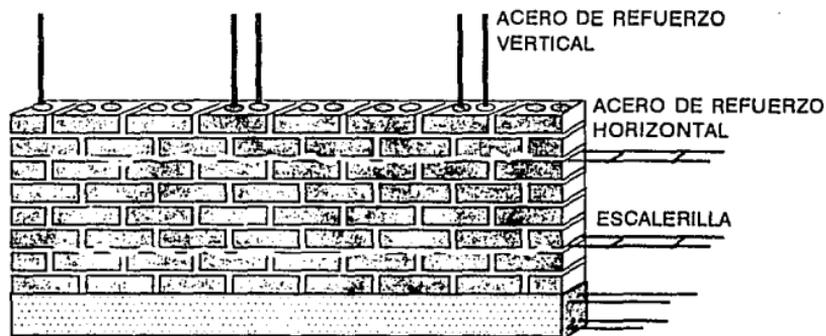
GRIETAS HORIZONTALES POR OXIDACION DE LA ESCALERILLA DE REFUERZO
